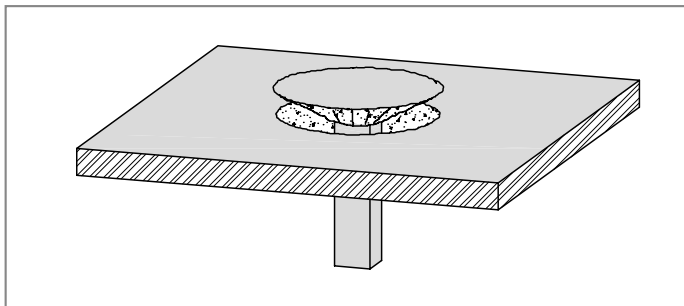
Rupture par poinçonnement d'une dalle en béton armé en tête de poteau
